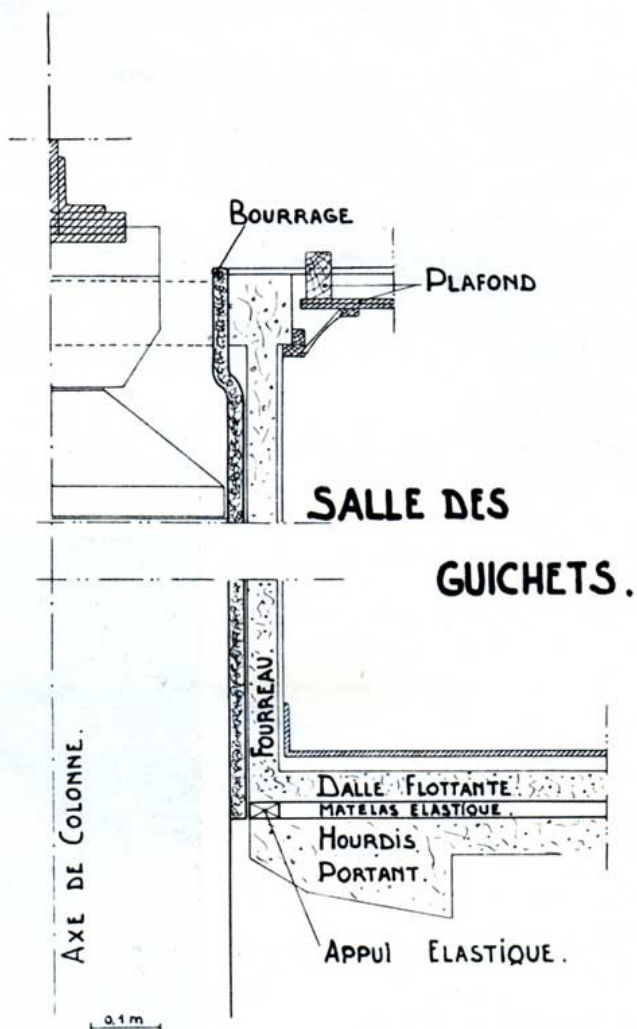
Coupe verticale d'un fourreau d'une colonne de la salle des guichets.
